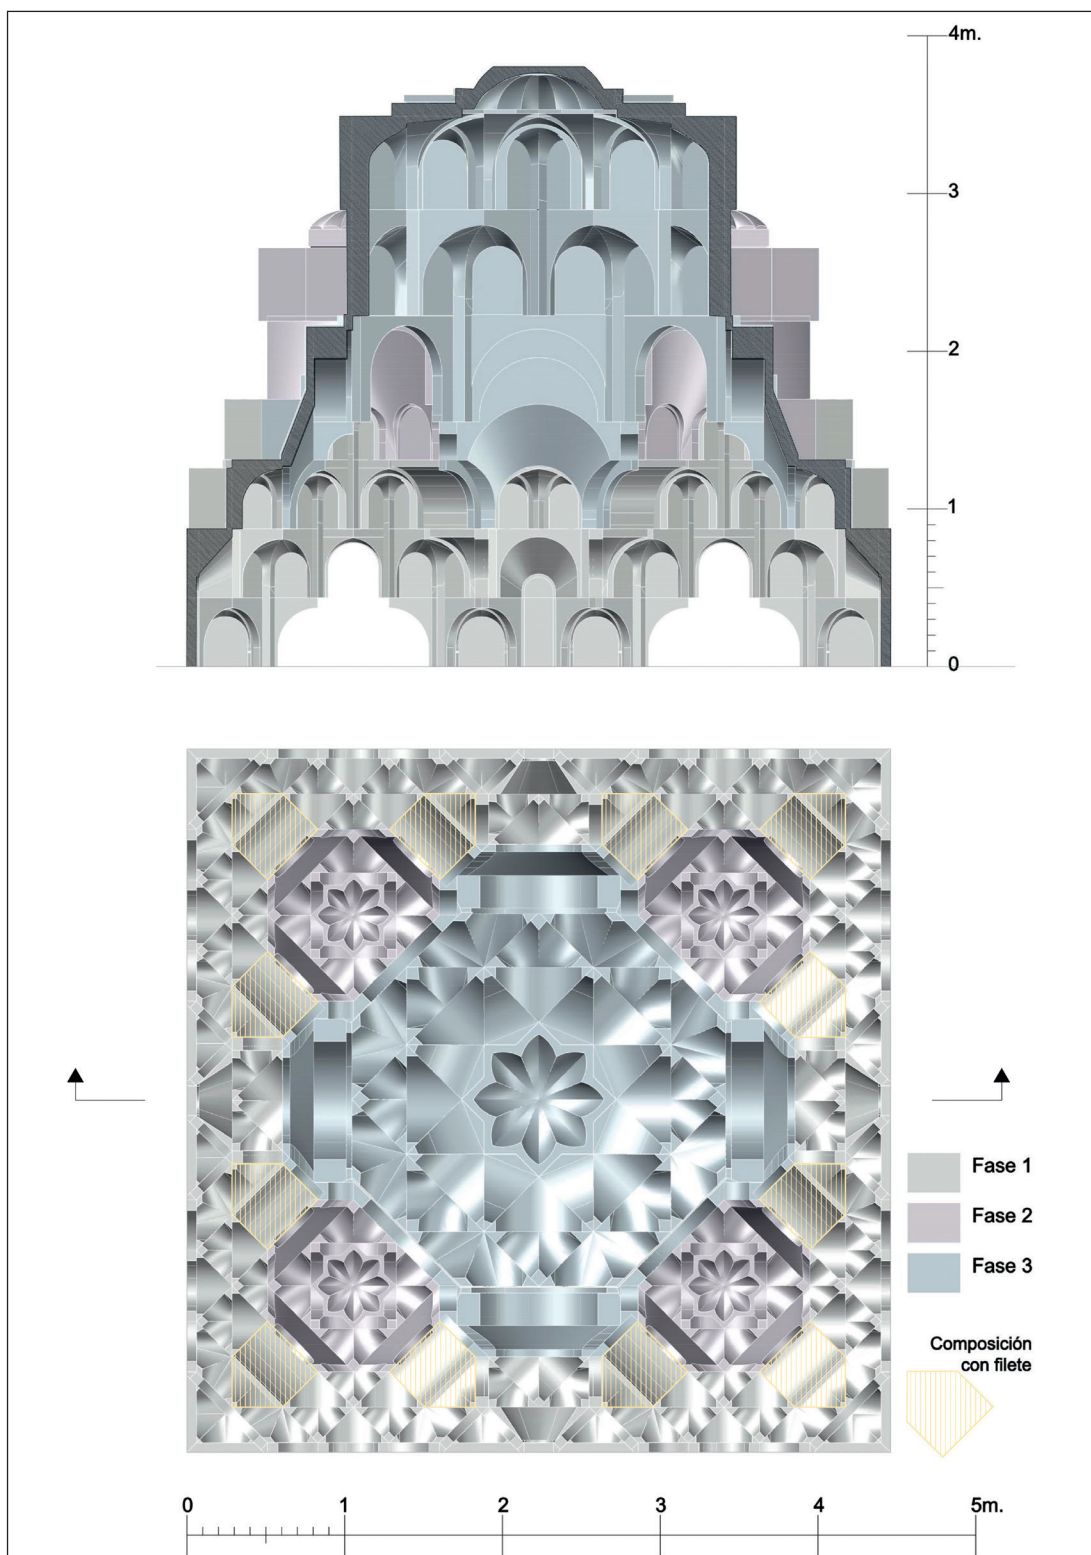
Planta y sección de la segunda versión del modelo tridimensional elaborado para la bóveda T2.
